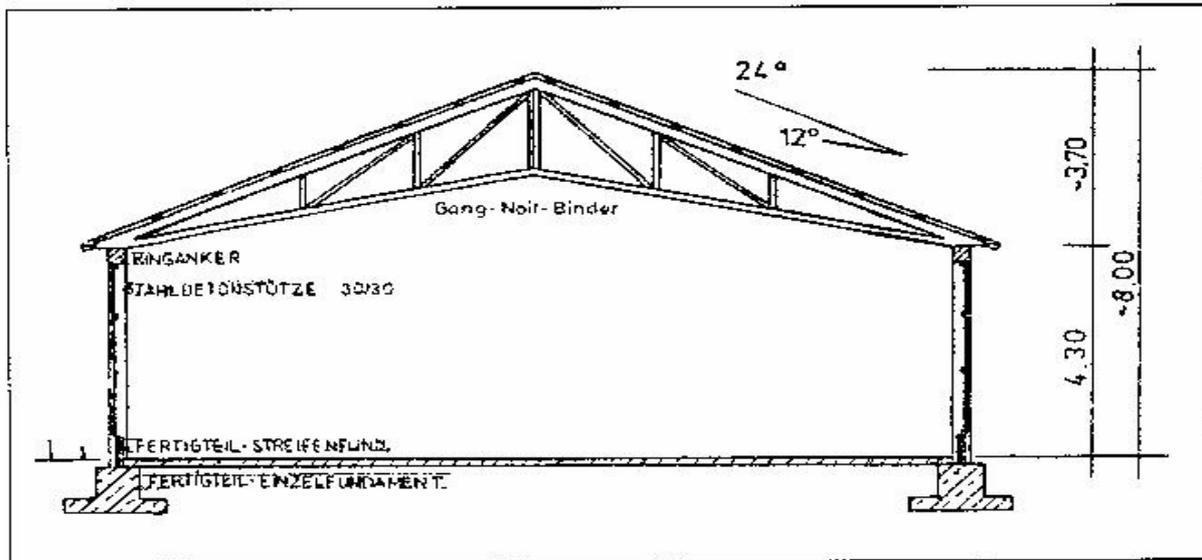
Beton-Gang-Nail-Halle (Werkbild Landbau – Schwarz GmbH)
